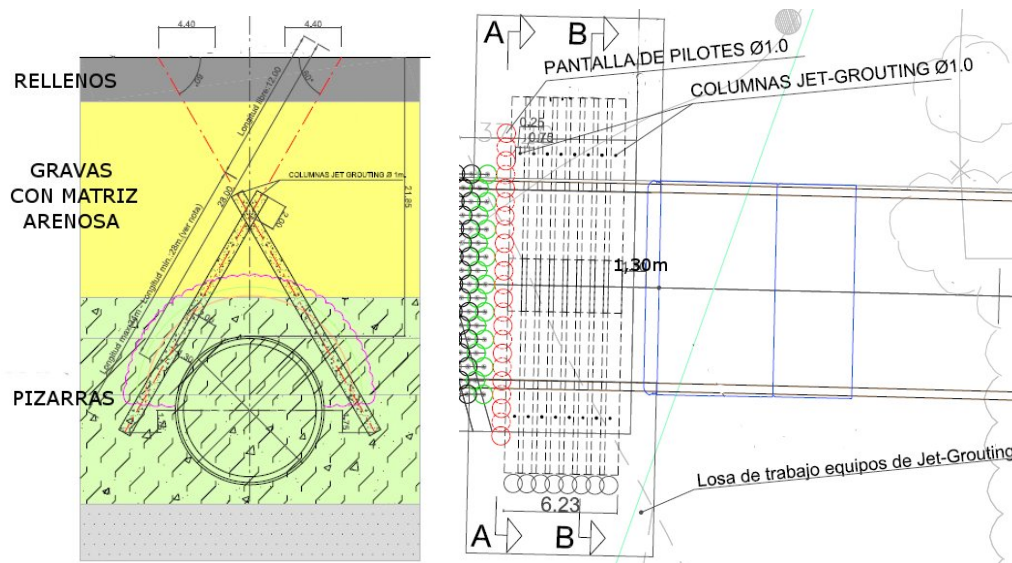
Vista en planta y alzado de la columnas de jet-grouting.
